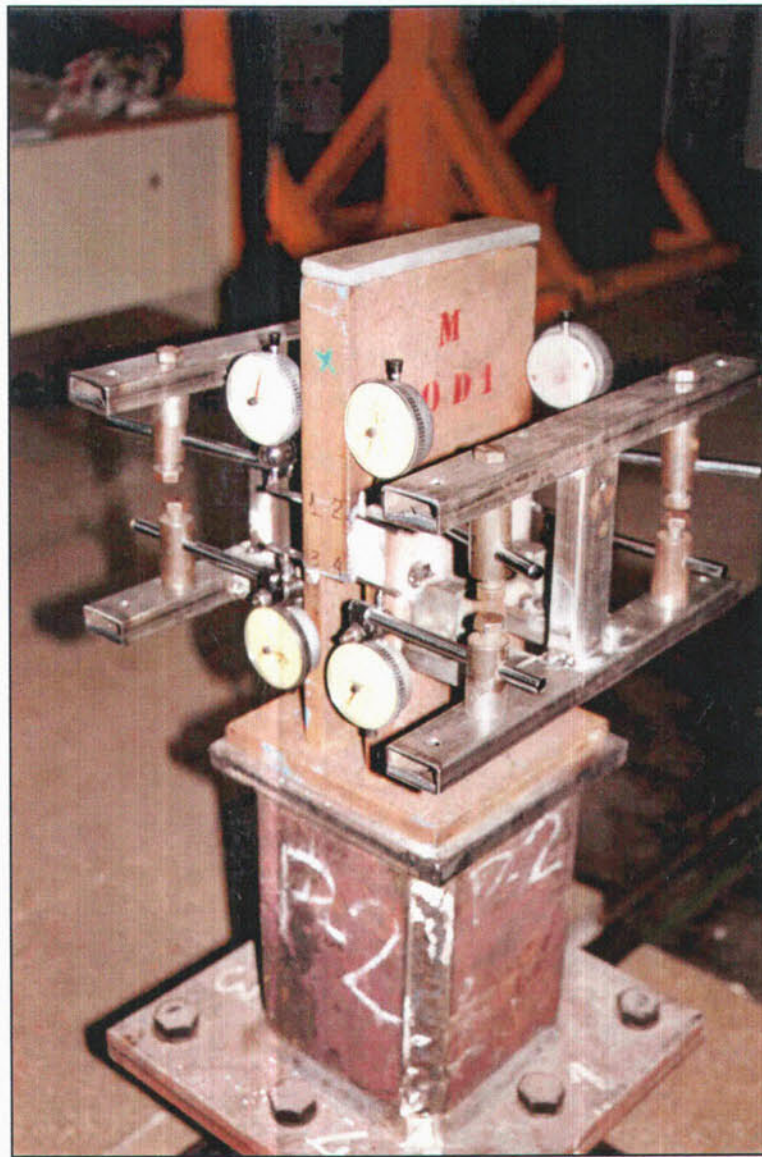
Probeta 1M con el equipo de flexímetros. En las soldaduras se ha realizado la pintura con cal.
